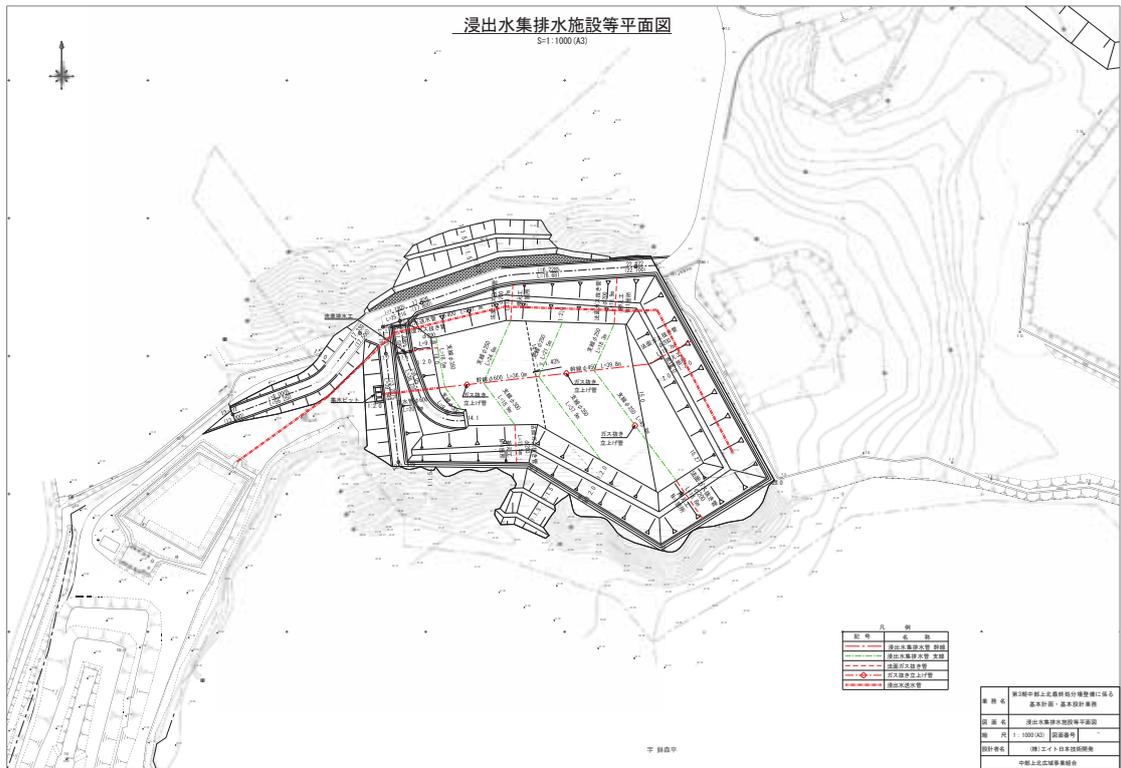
浸出水集排水施設、埋立ガス処理施設配置図
